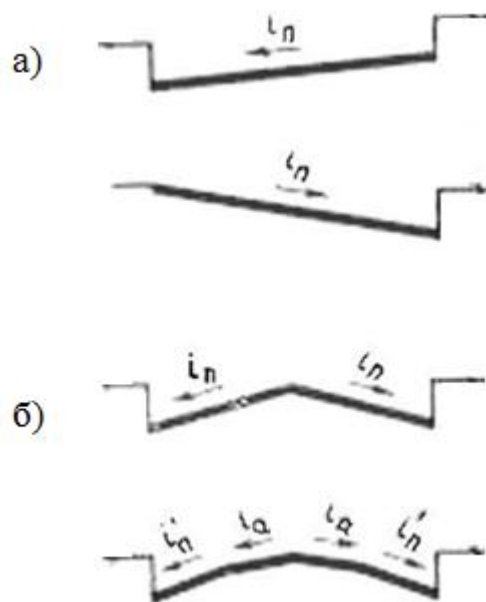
поперечный профиль проезжей части – а) односкатная схема; б) двускатная схема
